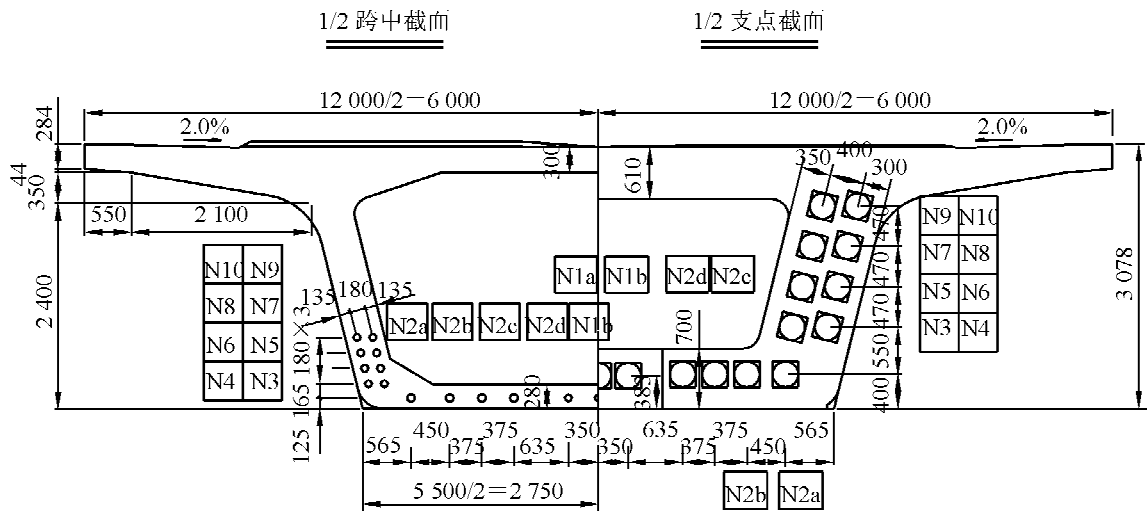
32 m 梁截面预应力筋布置图(单位:mm)
